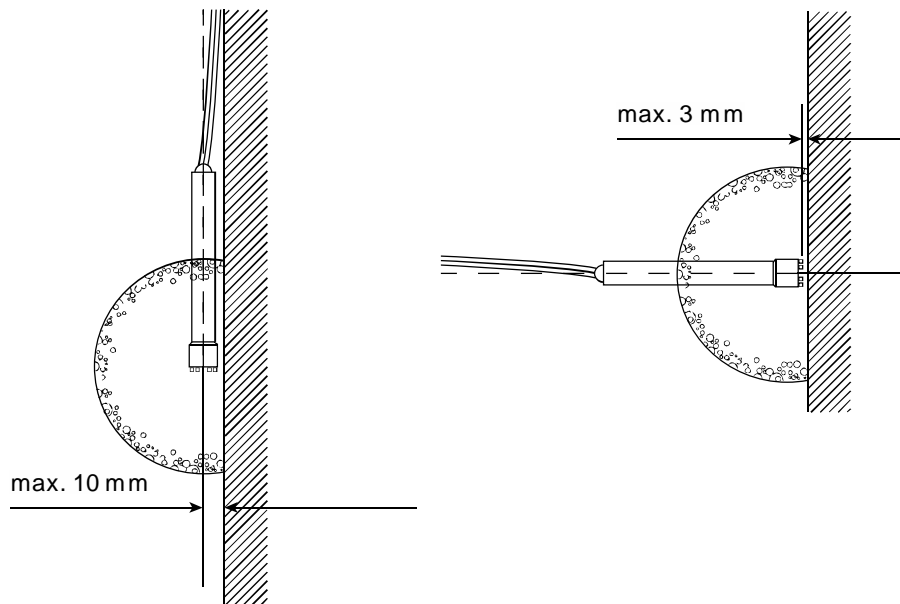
Prüfanordnung im Grundriss (links) und Schnitt (rechts)
